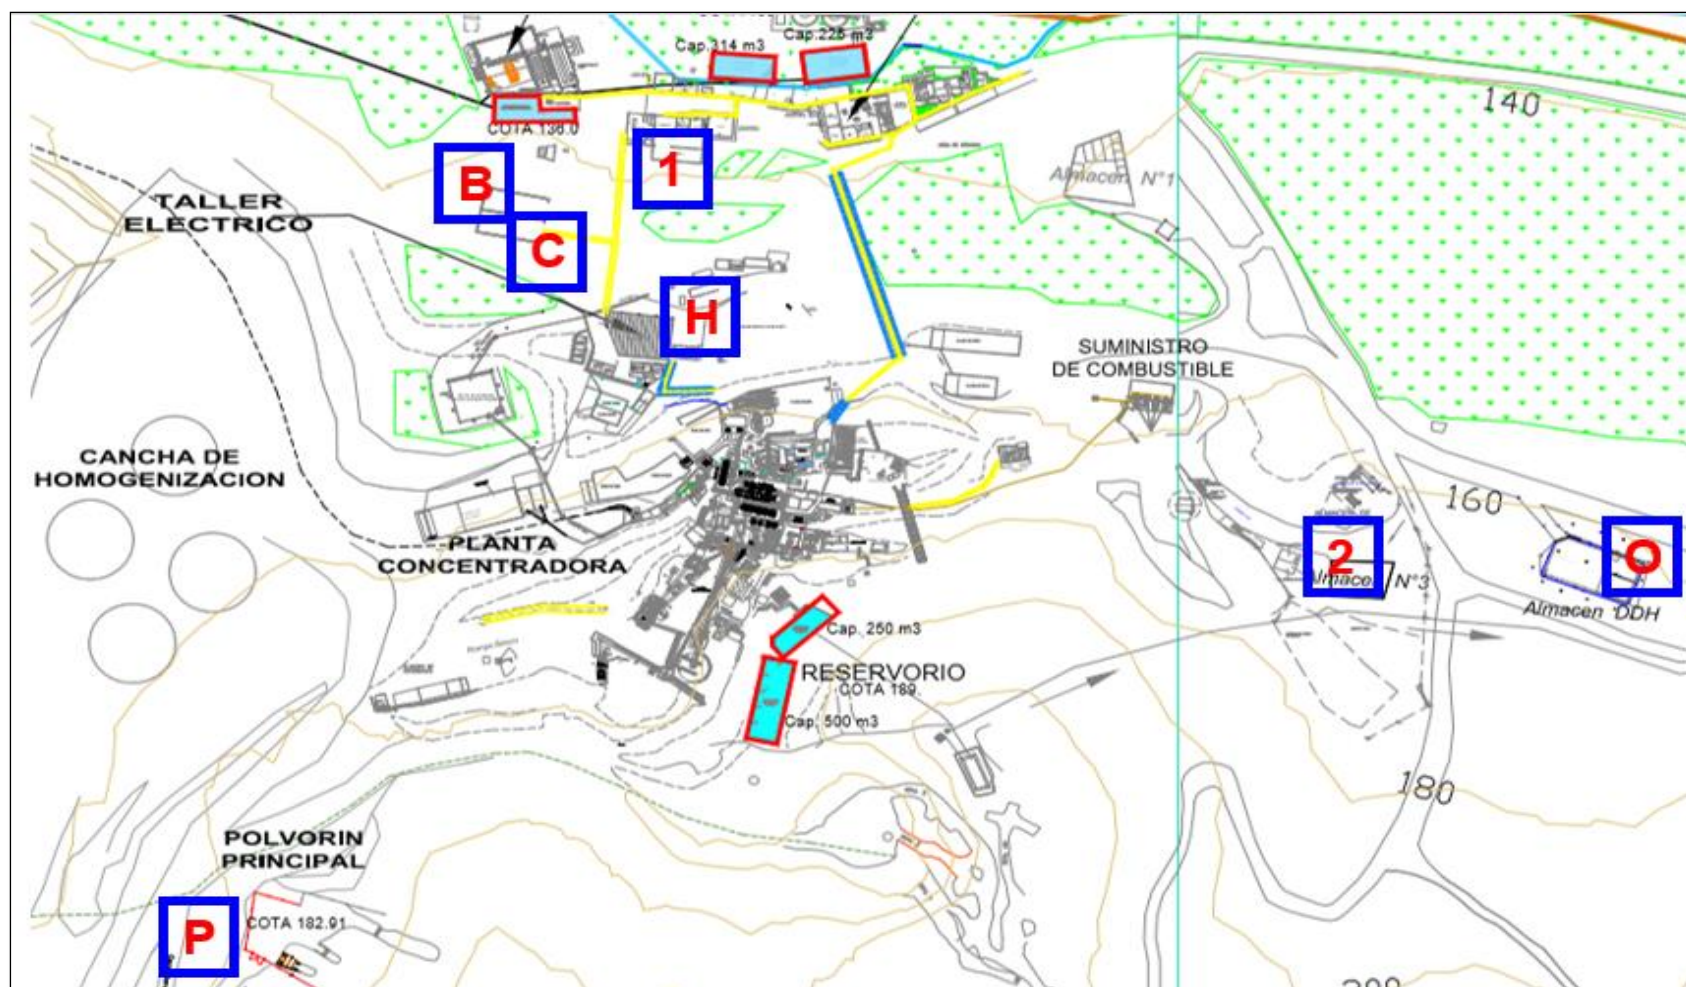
Plano de la Mina Colquisiri dividido en zonas
